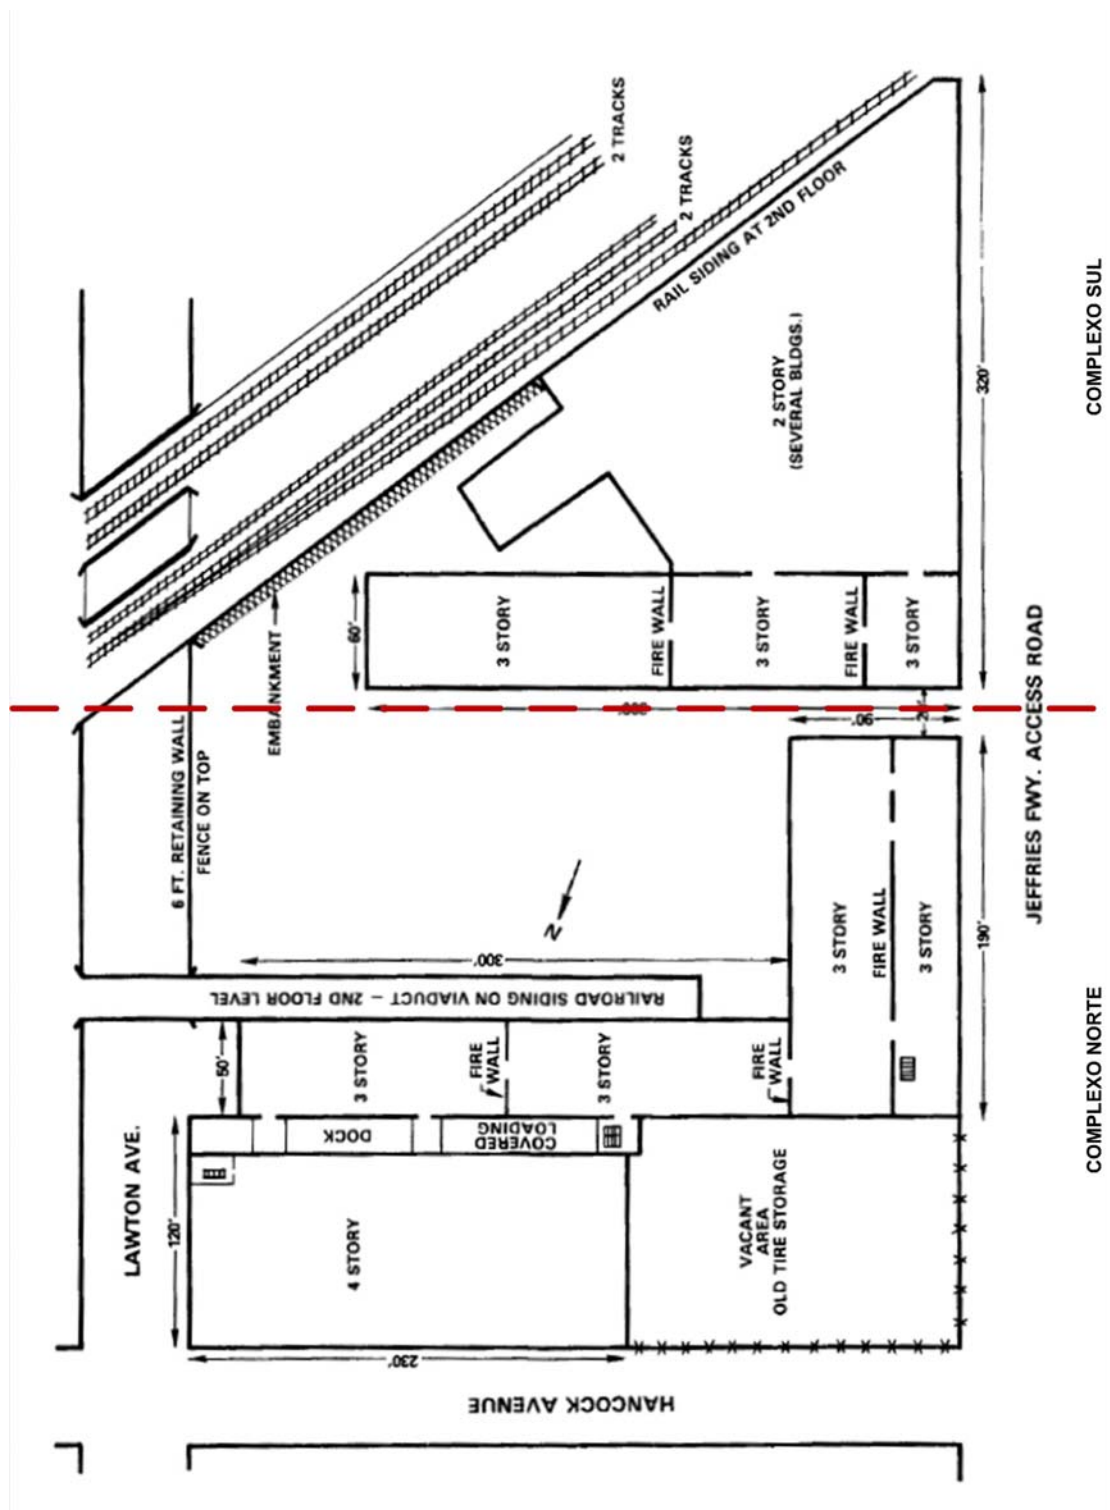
Envolvente/organização do complexo de norte e sul do Armazém em Detroit –
